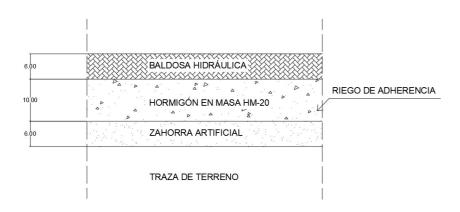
Sección transversal acera. Fuente: Elaboración propia.
